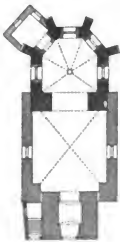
Wittingau. Grundriss der Friedhofskirche u. Aegidi.
